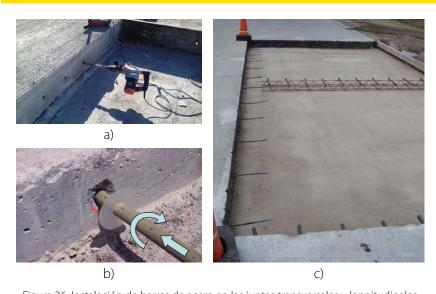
Instalación de barras de acero en las juntas transversales y longitudinales Fuente: Calo. (2018)
